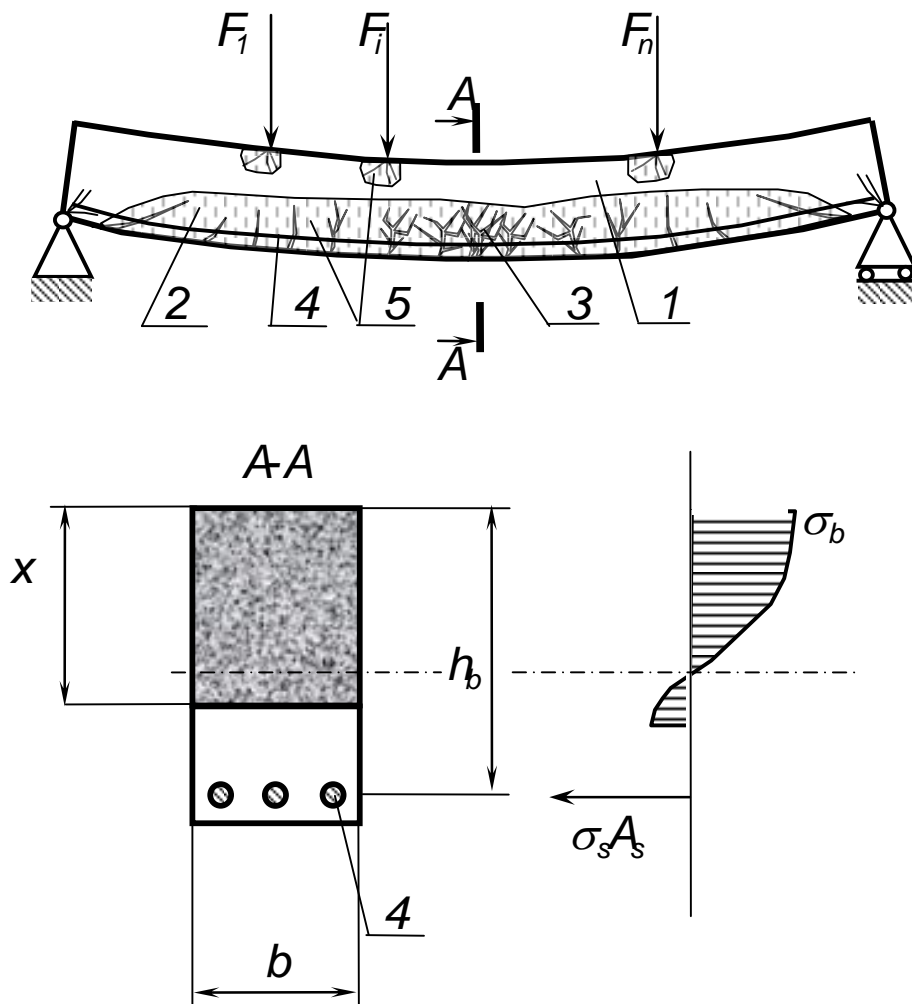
Схема роботи залізобетонної балки на згин: 1 – стиснута зона; 2 – розтягнута зона; 3 – тріщини в розтягнутому бетоні; 4 – арматура; 5 – зона пошкоджень бетону; F – силове навантаження
